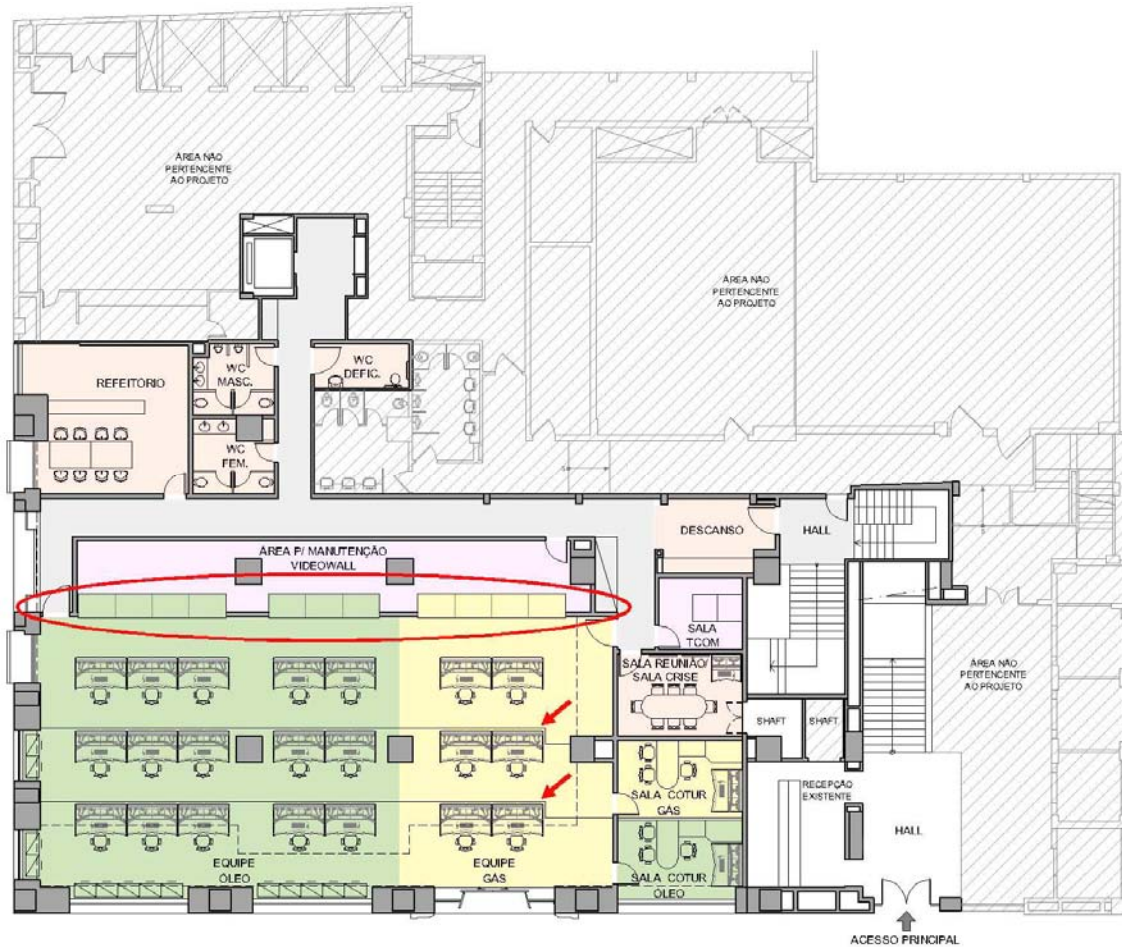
Planta baixa térreo: layout apresentado como resultado do *milestone 2
